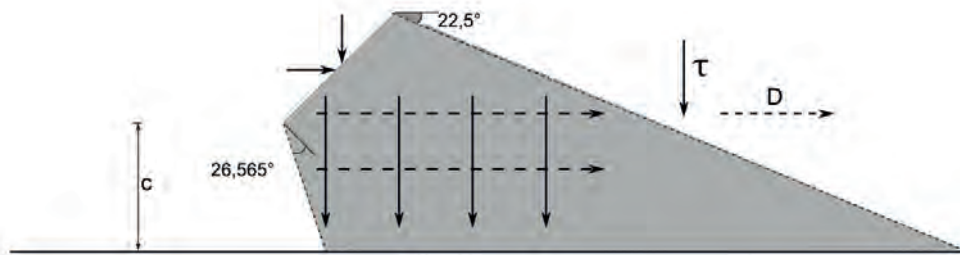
Verteilung der Querkraft und „Durchstanzen“ der unbewehrten seitlichen Betondeckung
